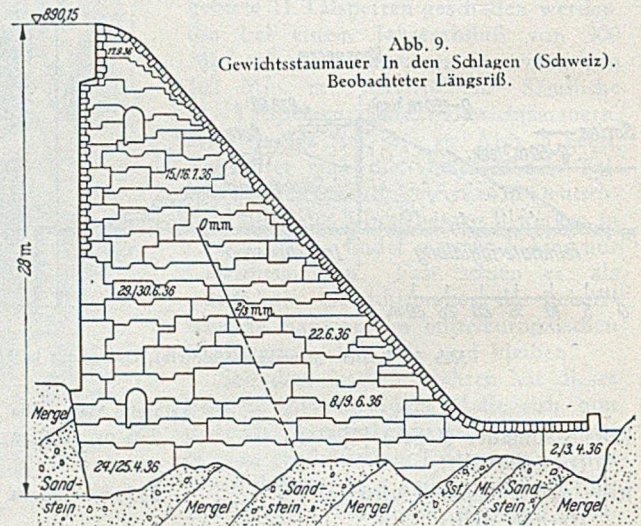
Gewichtsstaumauer In den Schlagen (Schweiz). Beobachteter Längsriß.
